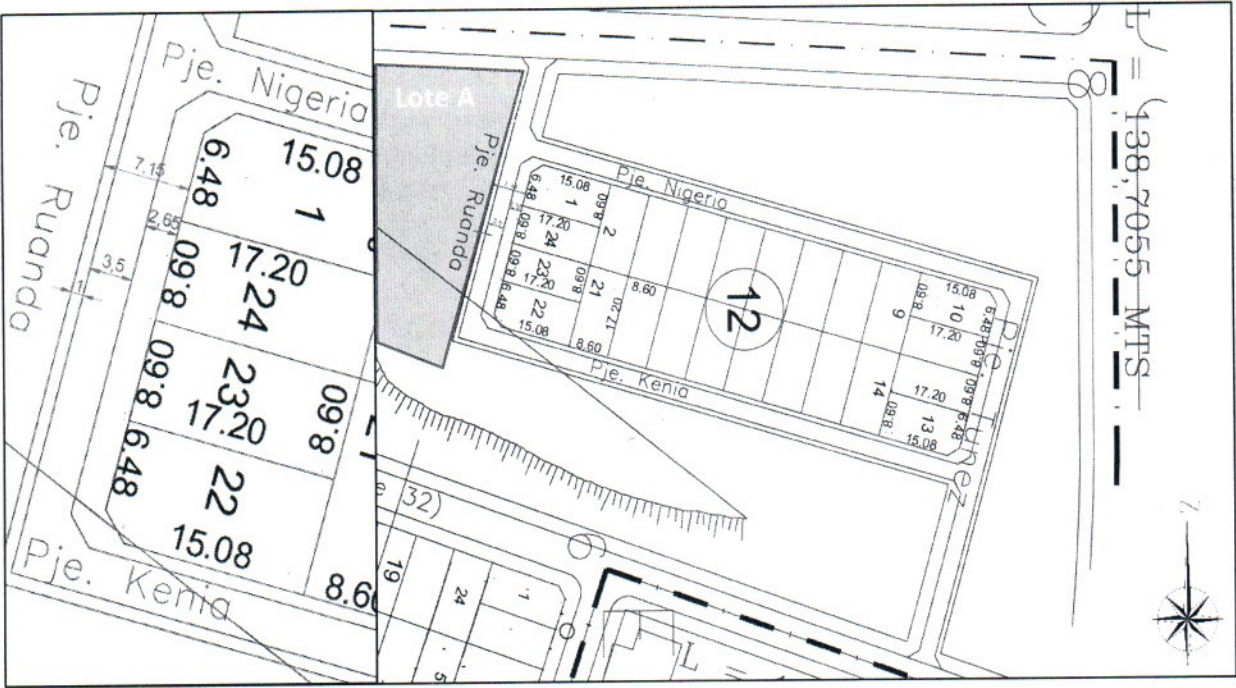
Lote A, Plano de Loteo La Pampa.
